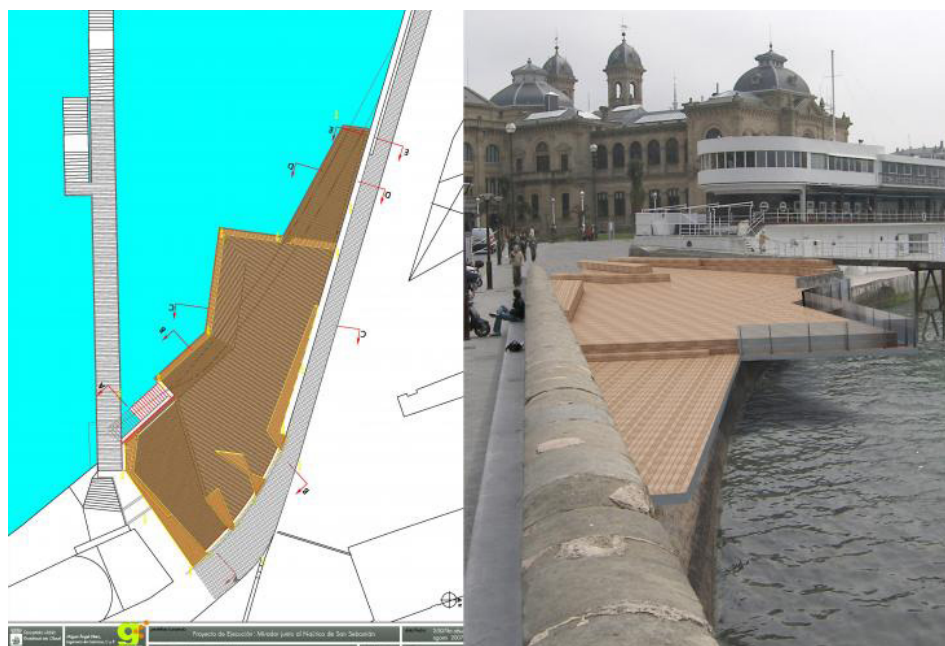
Proyecto del Mirador del Náutico. 2008. Girder Ingenieros
